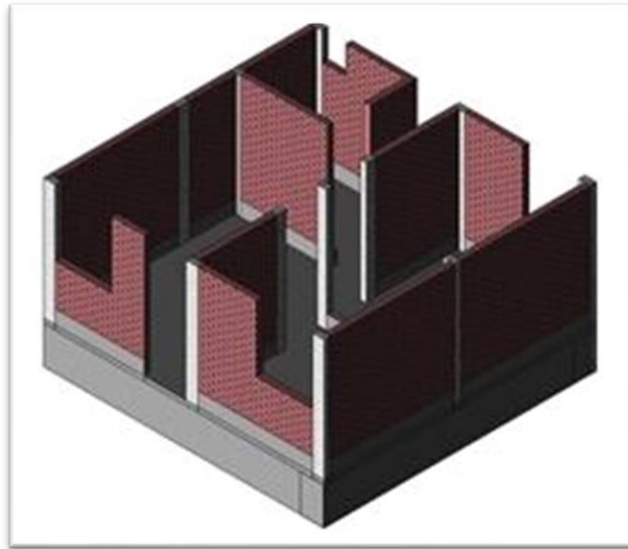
Visualización del modelado de columnas y vigas. Fuente: Propia.
